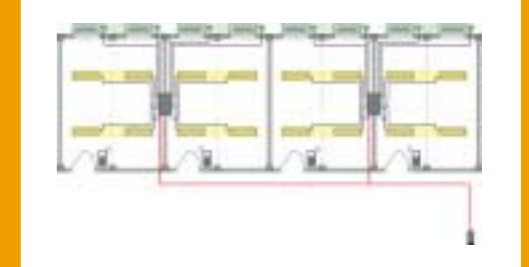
Achsenorientierte Installation mit Funkbedienung (ursprüngliche Planung)
